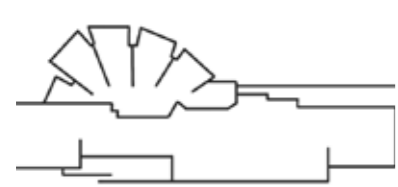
Planta esquemática da biblioteca Rovaniemi City.
